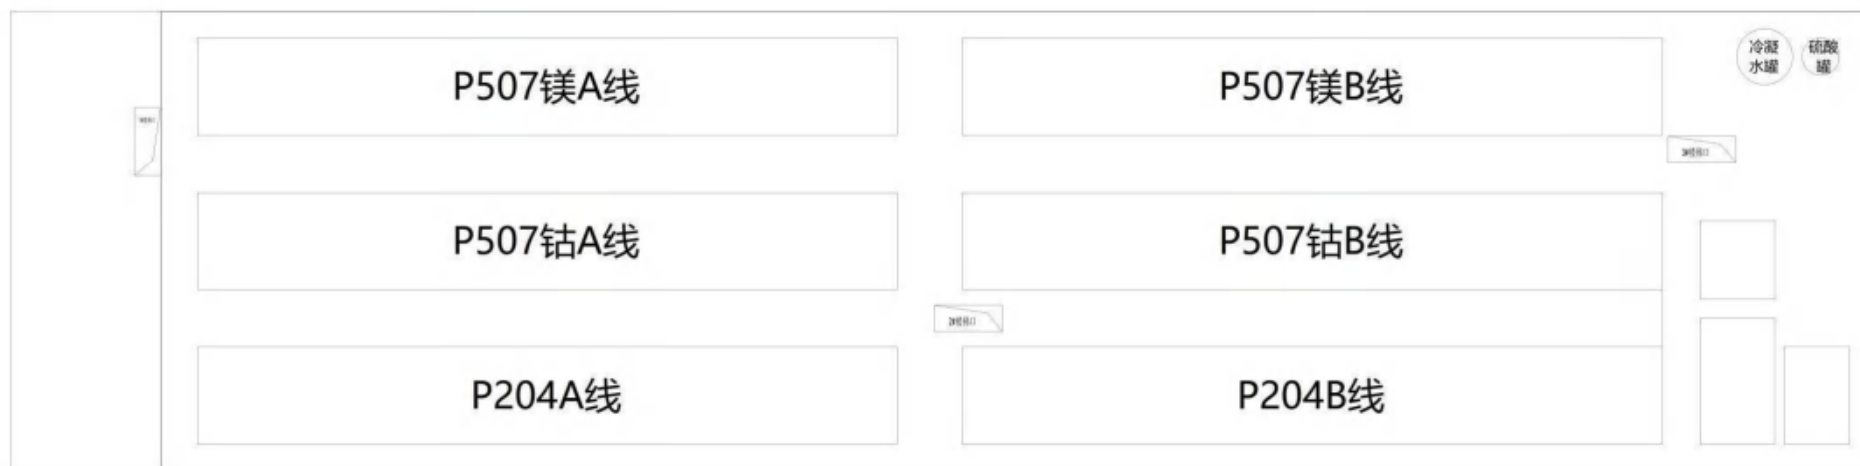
萃取二车间设备设施平面布置图 (2 楼)
